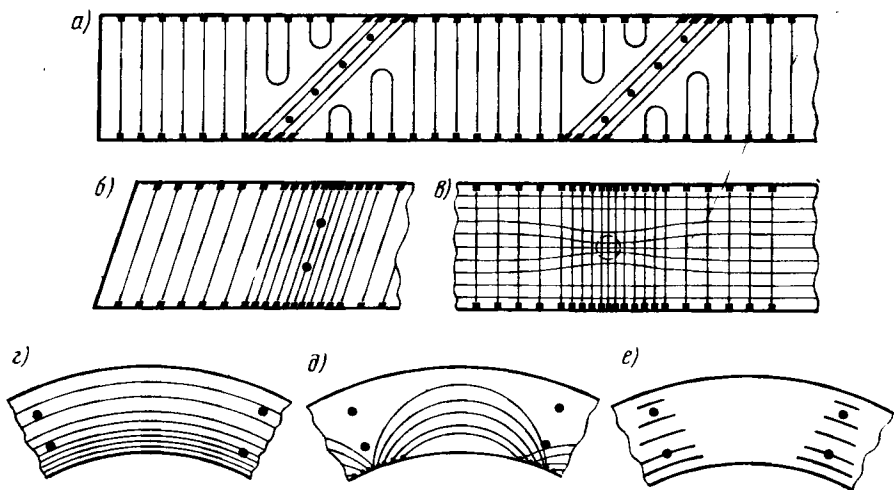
Схемы армирования плитных пролетных строений ненапрягаемой арматурой
